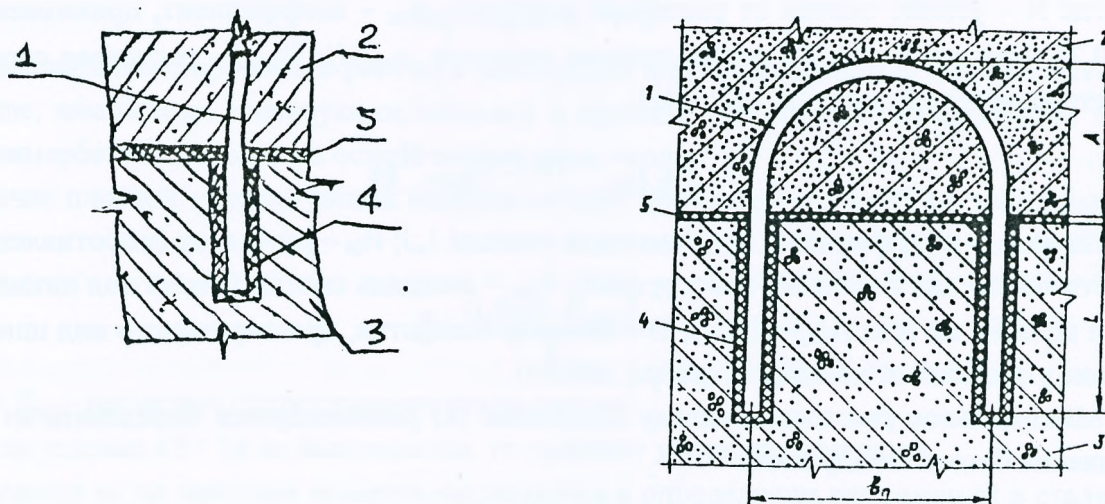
Схема усиления бетона усиления с ослабленной конструкцией: 1 – скоба (штырь); 2 – бетон усиления; 3 – ослабленный бетон конструкции; 4 – скважина, заполненная клеем; 5 – клеевая обмазка.
